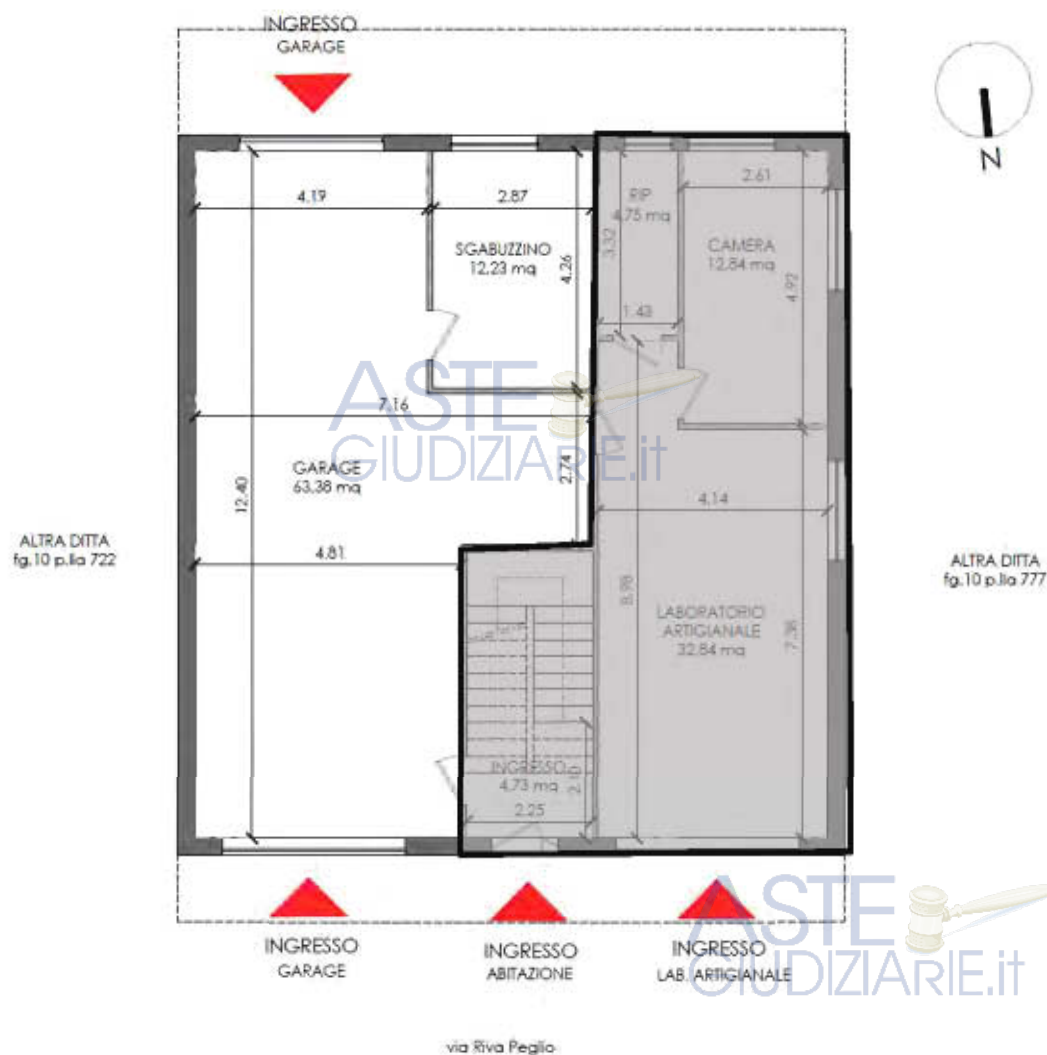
Rilievo Stato di fatto Lotto 3, Locale Garage_ pianta piano terra (Allegato 6D)
